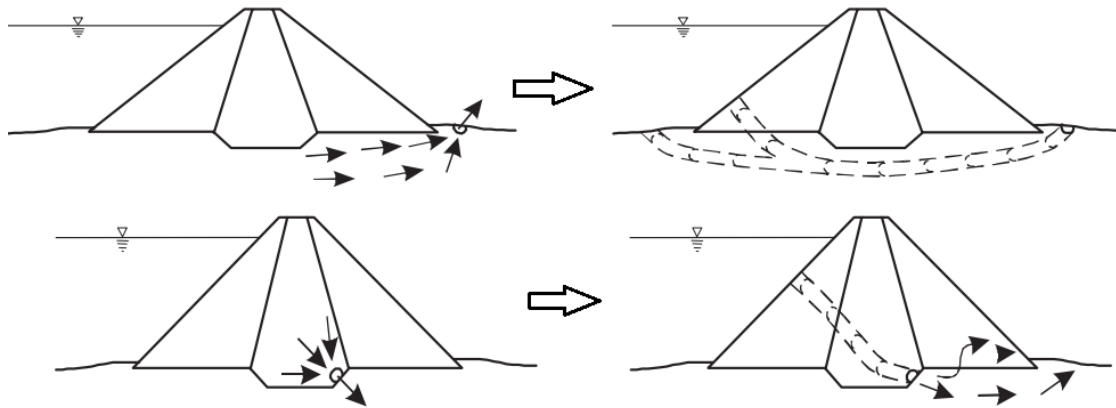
Esquema da ocorrência de *piping* ao longo da fundação e do maciço da barragem. Fonte: Adaptado de Fell e Fry, 2007.
